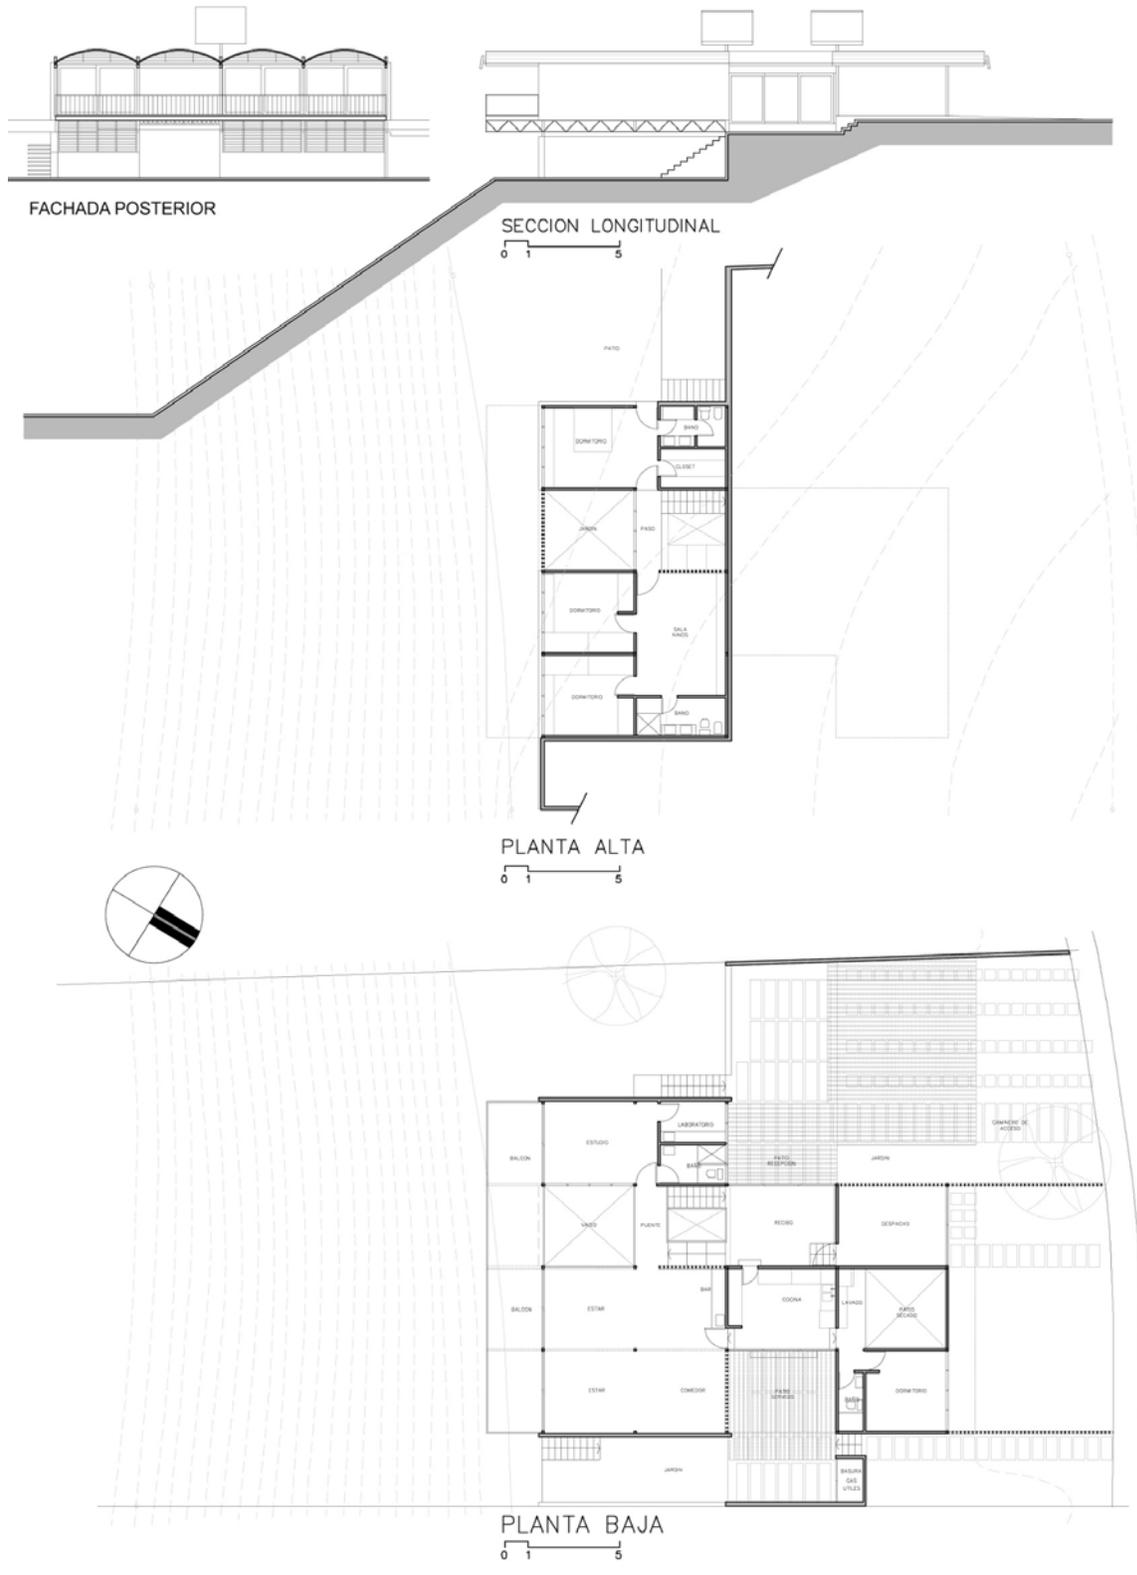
Plantas baja, alta, alzado y sección de la vivienda
